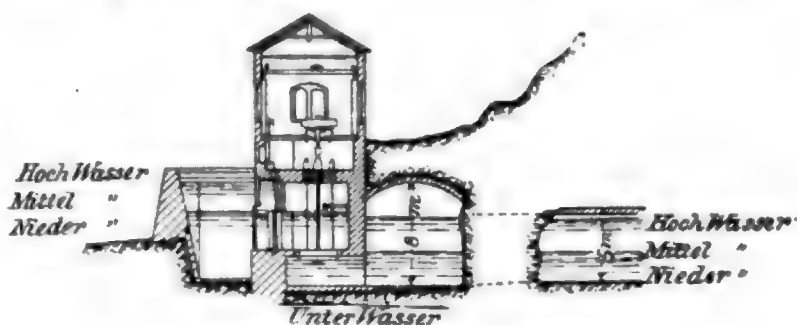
u. 8. Maschinenhaus. Schnitte.
